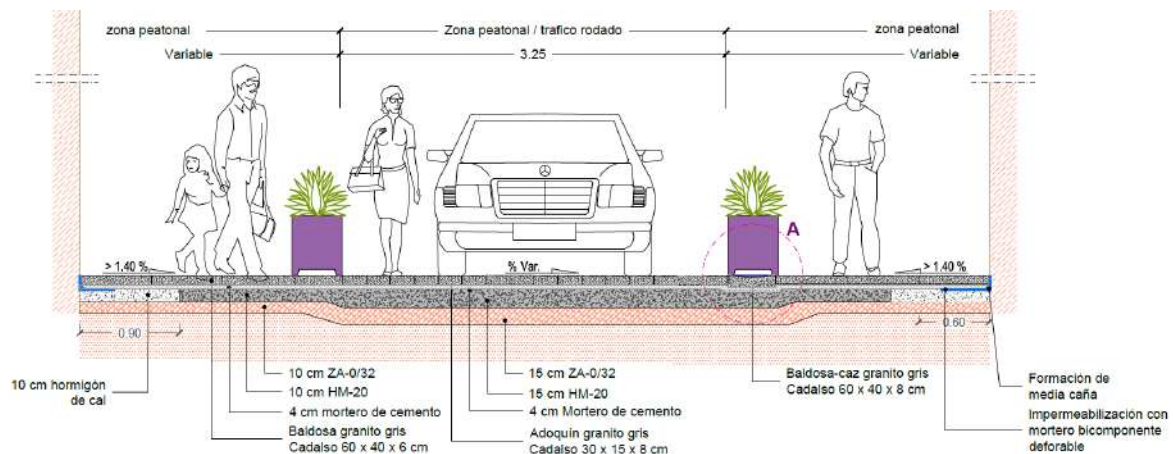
Croquis sección tipo, en zona de demolición completa
